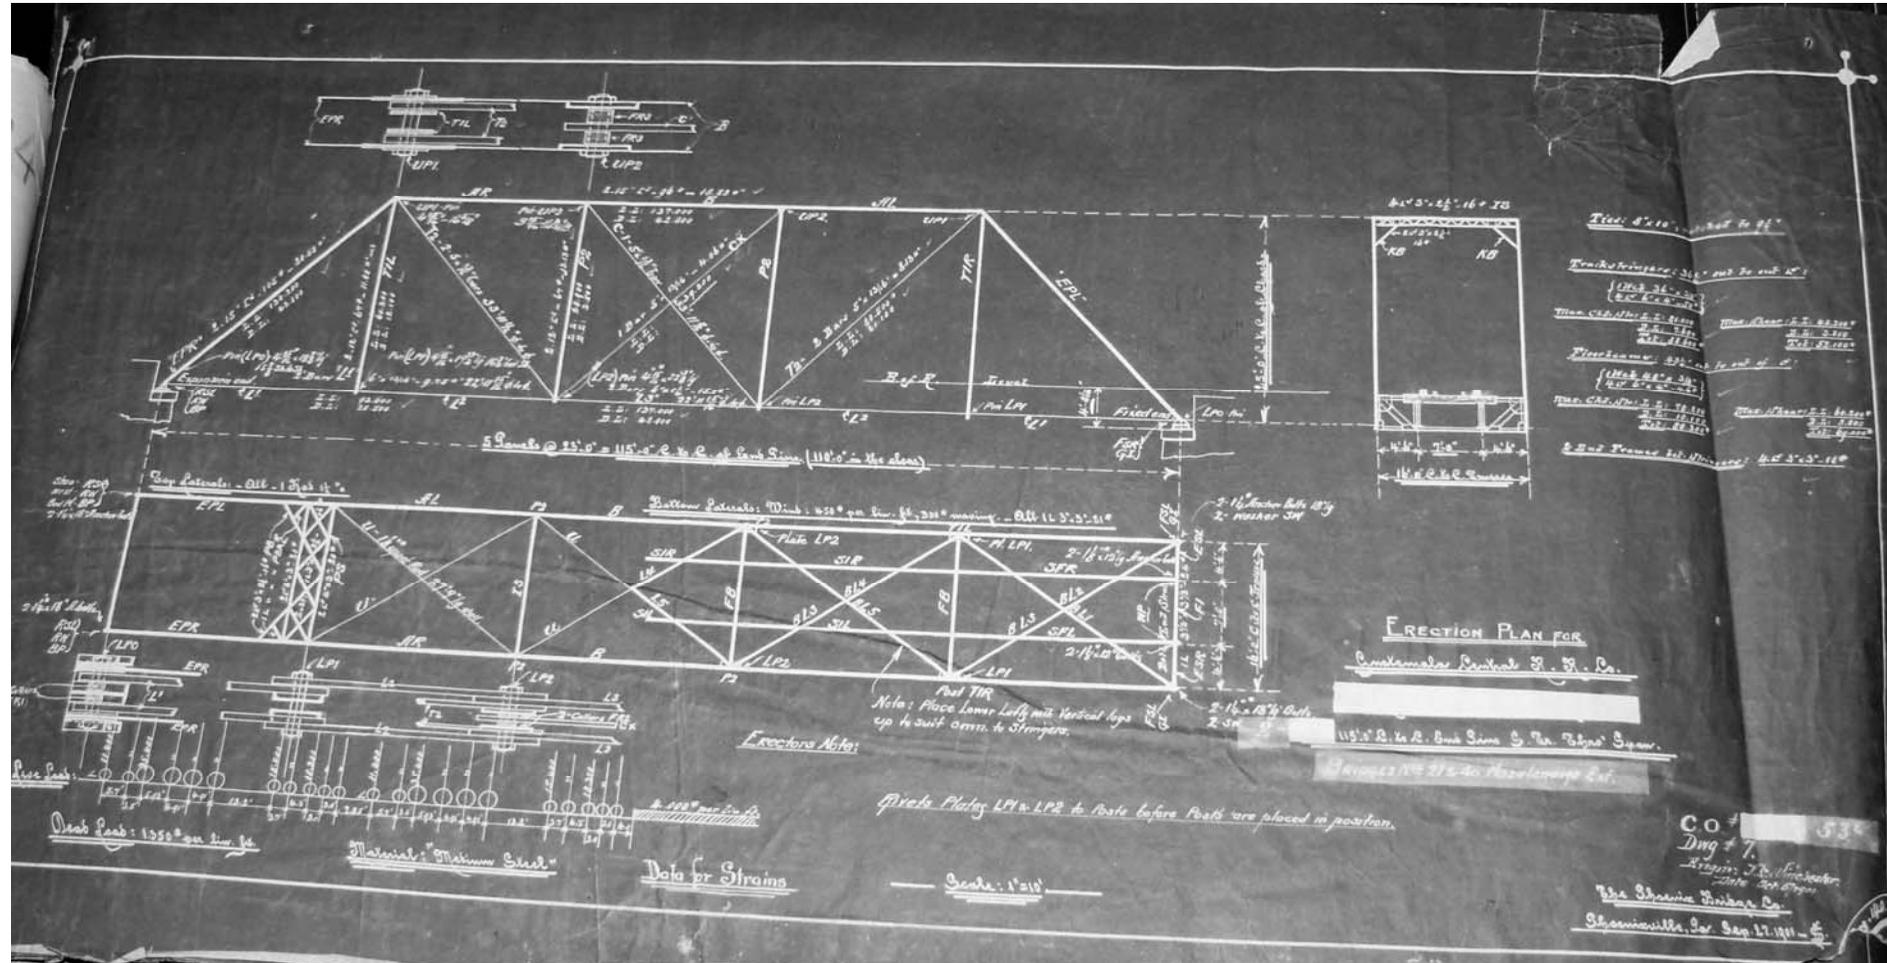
y 123. Planos de puente sobre vía férrea en salida de Mazatenango hacia Santo Domingo Suchitepéquez. Encontrados en archivo de FEGUA.
